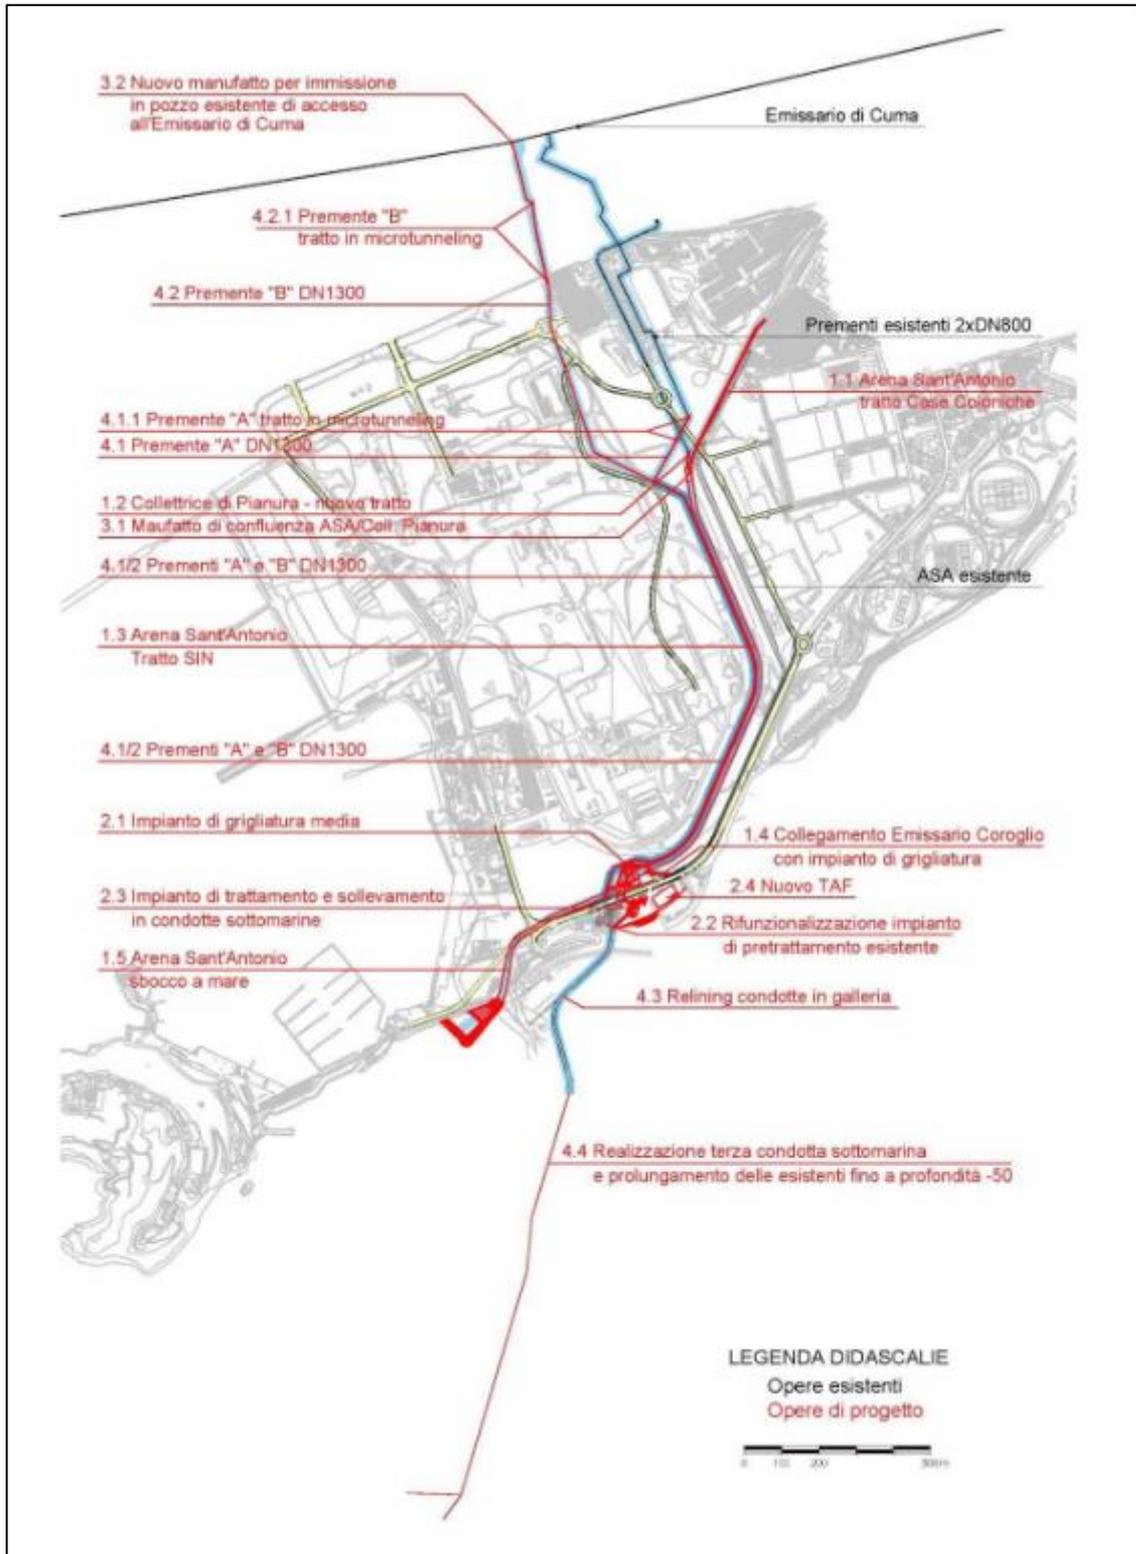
Planimetria schematica delle opere idrauliche di progetto
